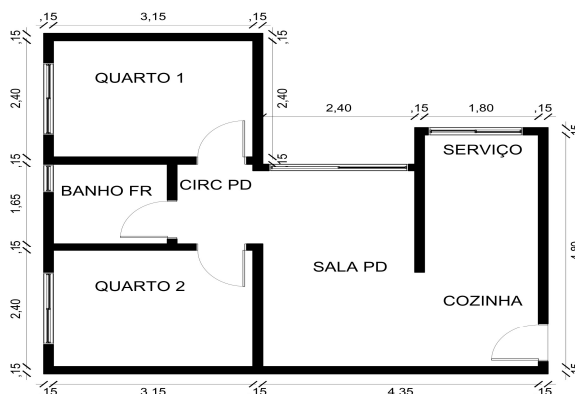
Planta baixa do apartamento tipo, do projeto de referência 2. Fonte: Caixa Econômica Federal (2018b).
